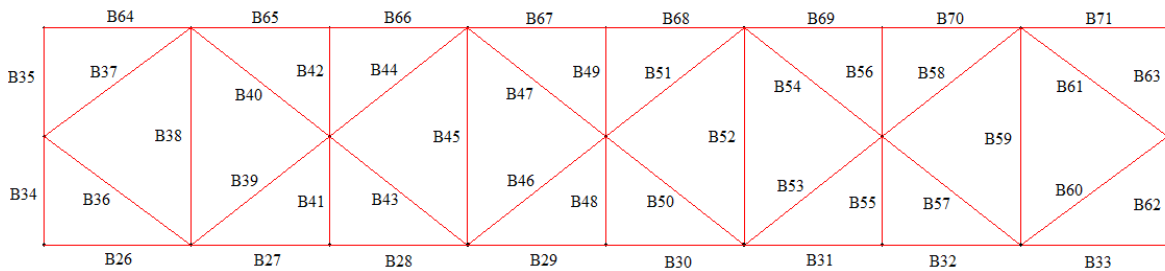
Vista en planta de las cuerdas y diagonales superiores de la armadura con numeración de elementos.
